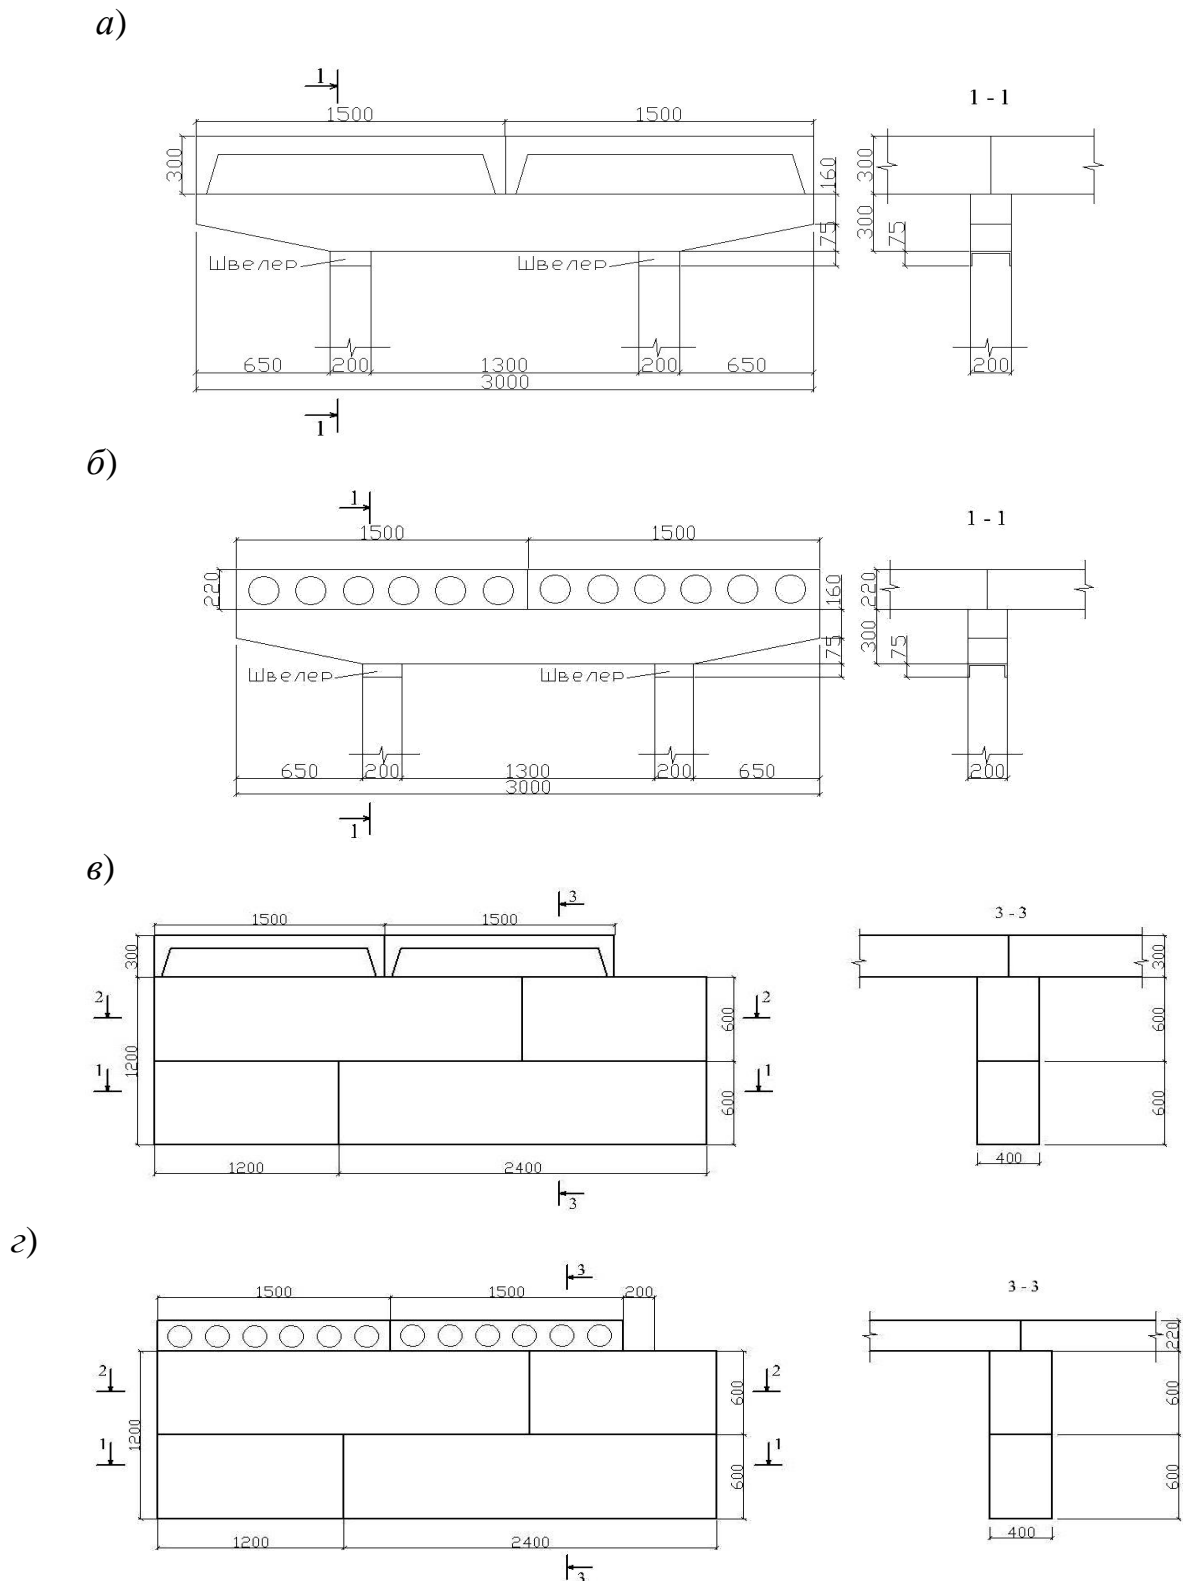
Конструкція високих пасажирських платформ типу II: опори – залізобетонні стояки та ригель (а, б), або блоки бетонні для стін підвалів (в, г); покриття – залізобетонні ребристі плити (а, в) або залізобетонні багатопустотні плити (б, г)
